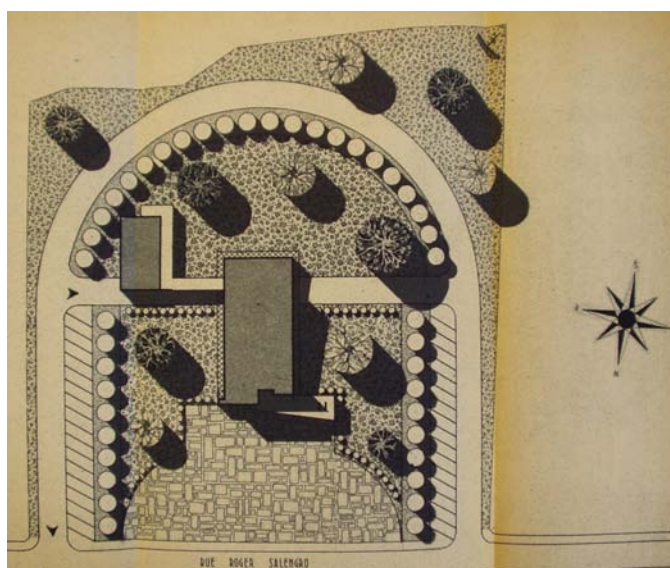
Plan masse 15-02-67 (AHDL 6 L 171)
